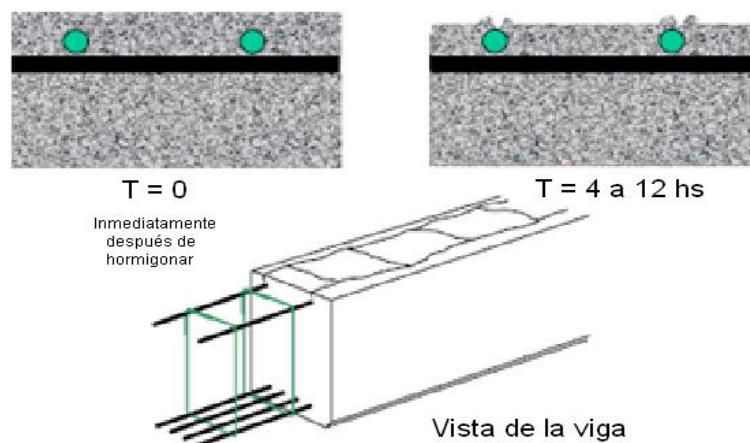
Fisuras por asentamiento plástico en vigas (BECKER, 2010 a)
